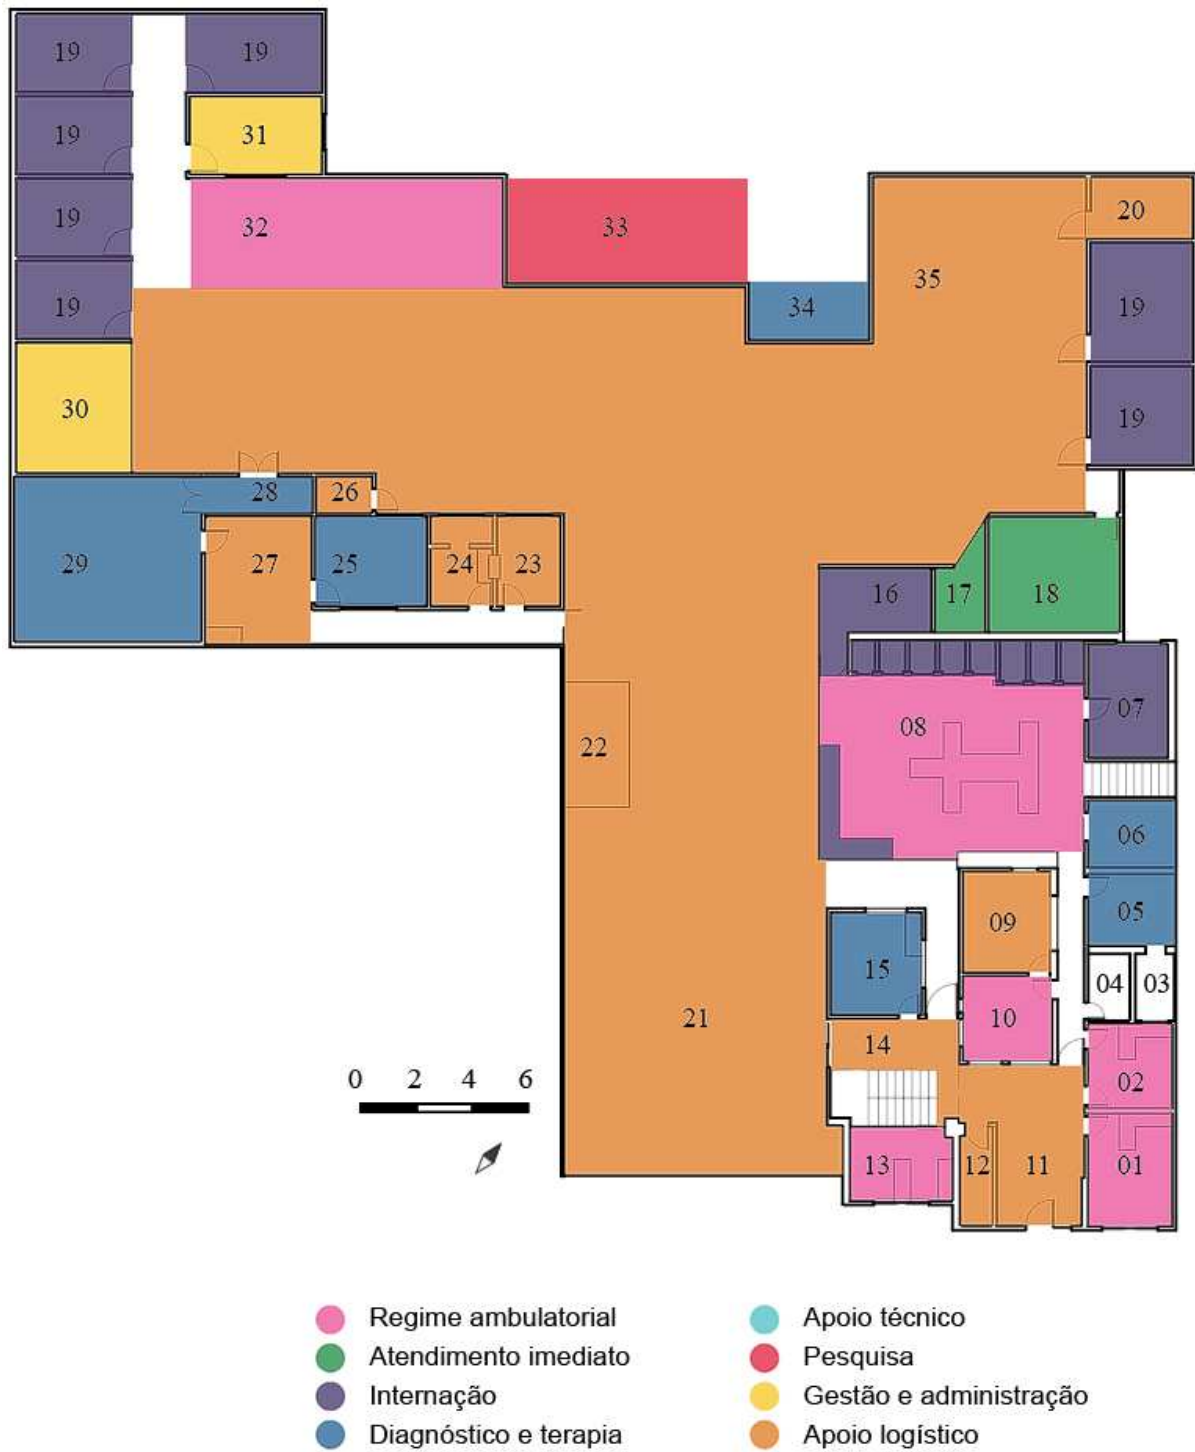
Distribuição setorial do 2º pavimento da Instituição A
